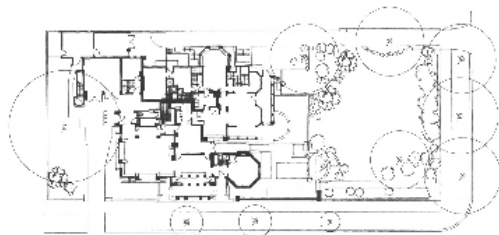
Planta baja, casa Estudio Wright 1889-1890, Oak Park, Chicago
